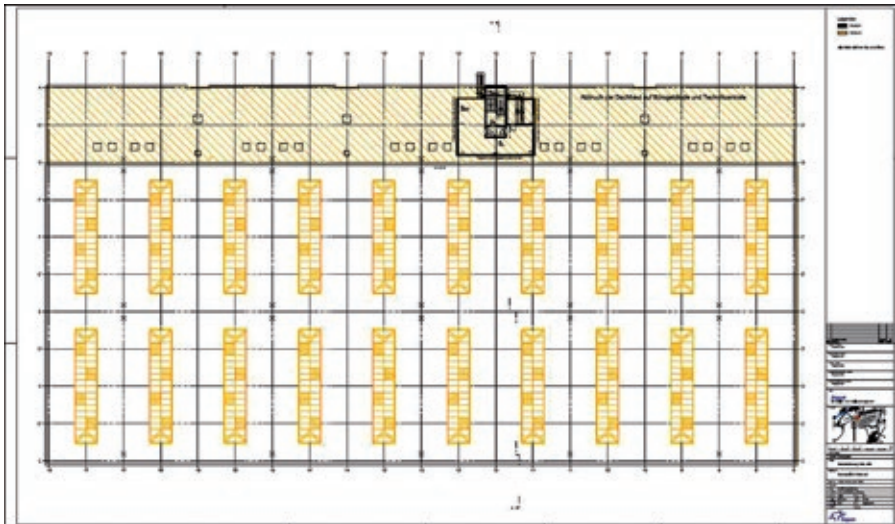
Grundriss der mehrschiffigen Lagerhalle mit Oberlichtern (gelb)
